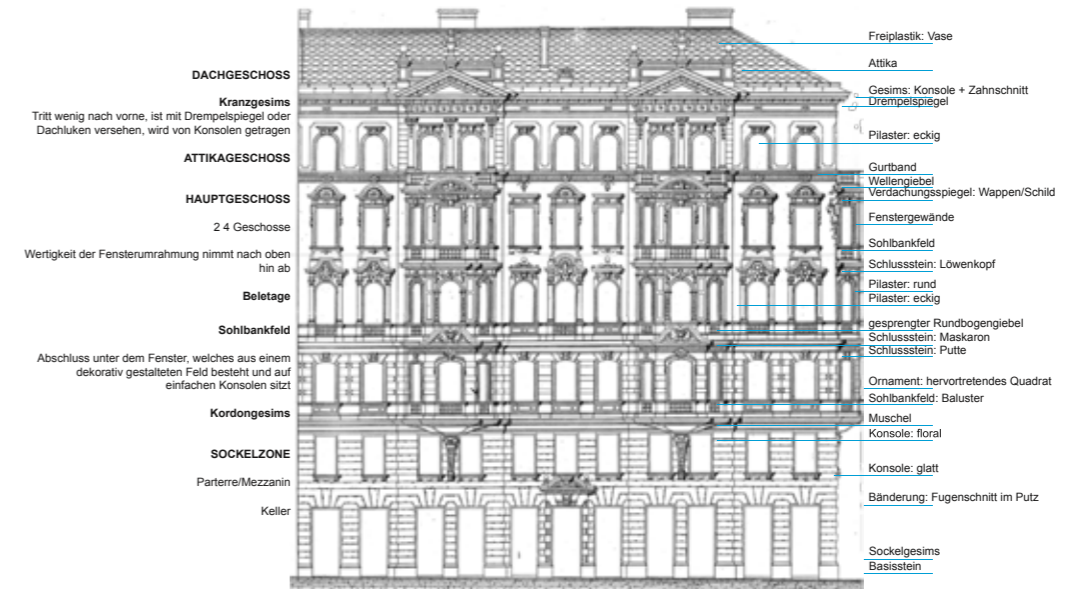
Gebäudefassade Spätgründerzeit, Wien
